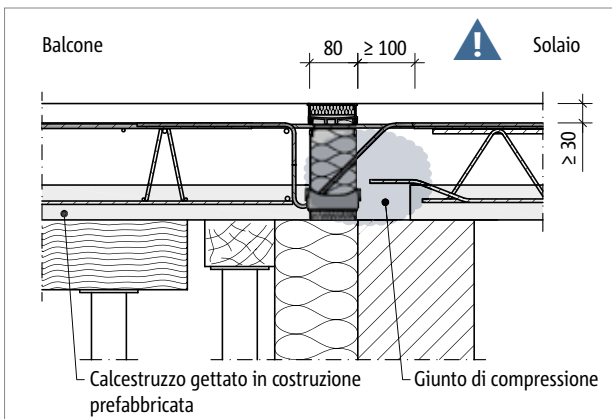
Schöck Isokorb® T tipo K/K-F: appoggio diretto, montaggio con solette semiprefabbricate (qui:  $h \leq 170$  mm), giunto di compressione lato solaio
